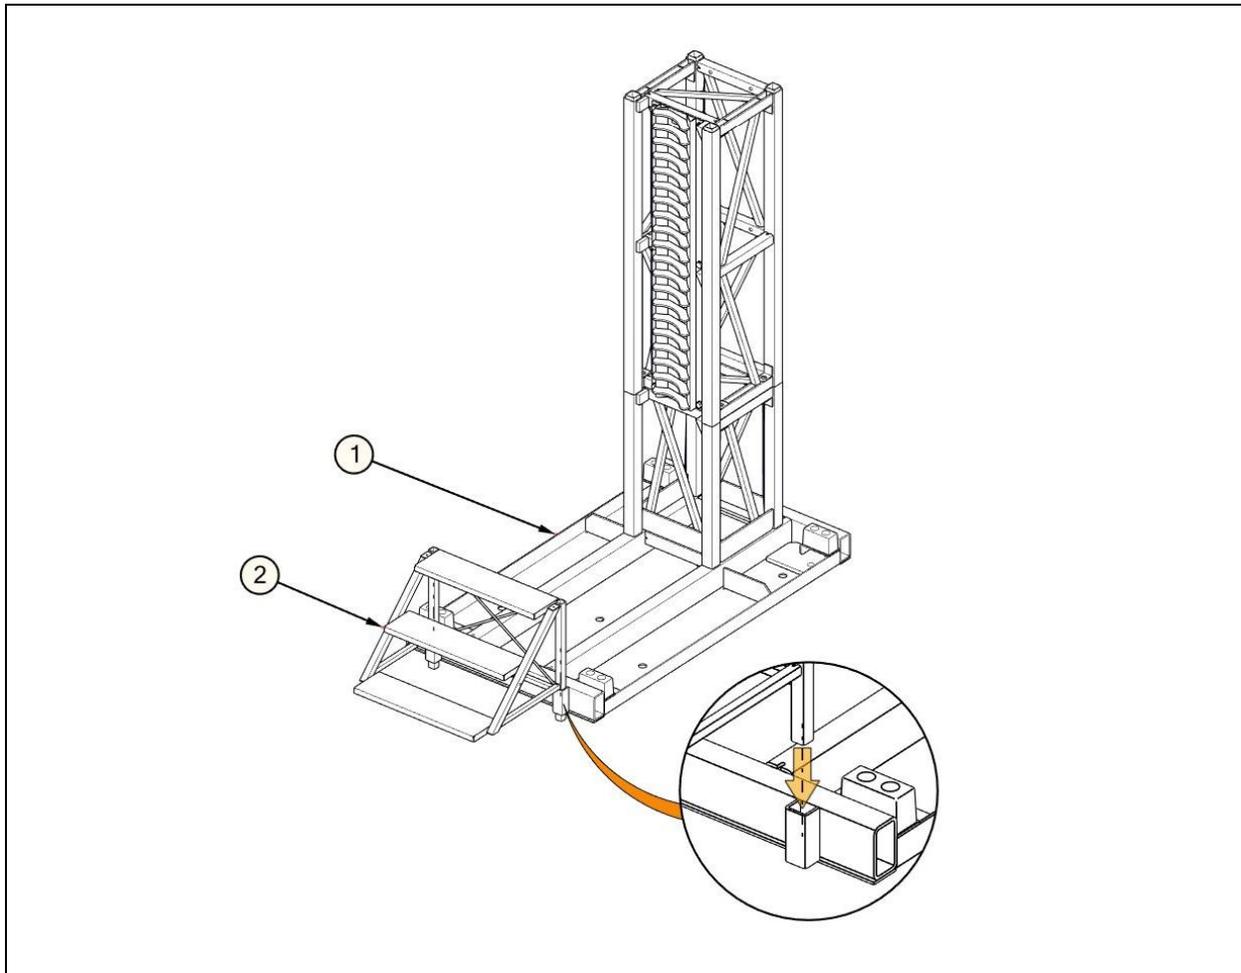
Installation de l'escalier 3 marches sur base au sol
